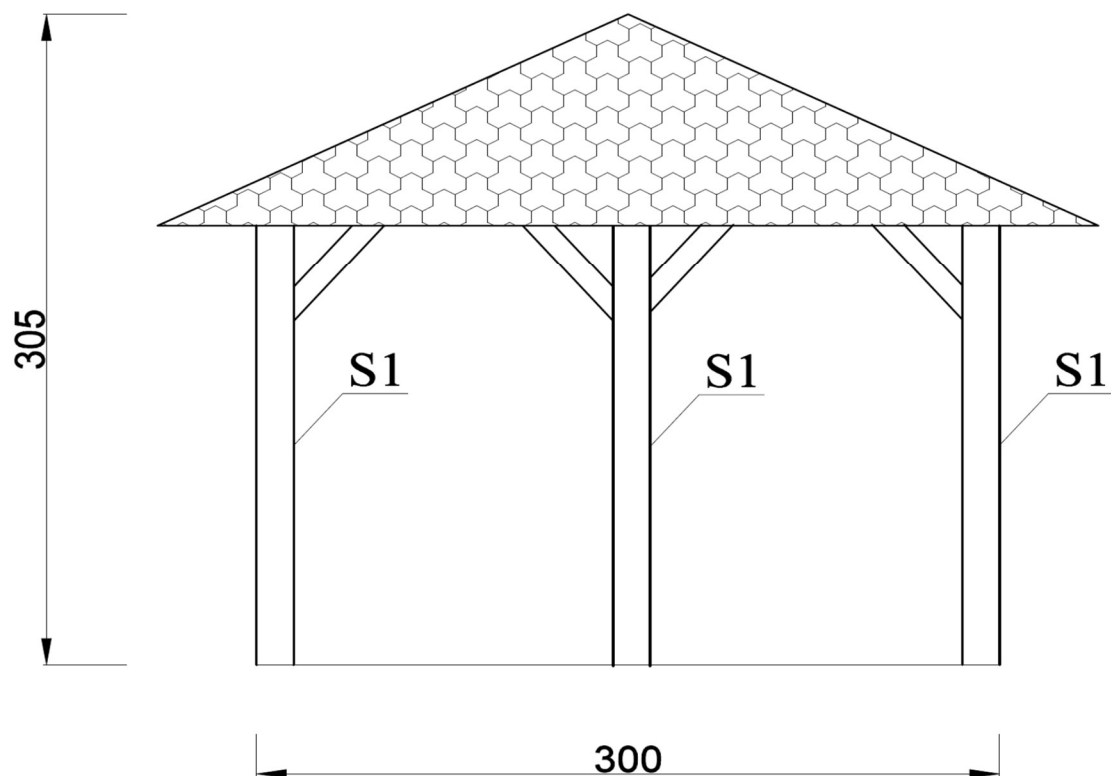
Elewacja tylna projektowanej altany drewnianej wraz z ławkami i stolikiem – rzut poziomy, S1 – słupy drewniane 15x15 cm. Na dachu projektuje się pełne deskowanie, pokrycie dachu gontem bitumicznym.
